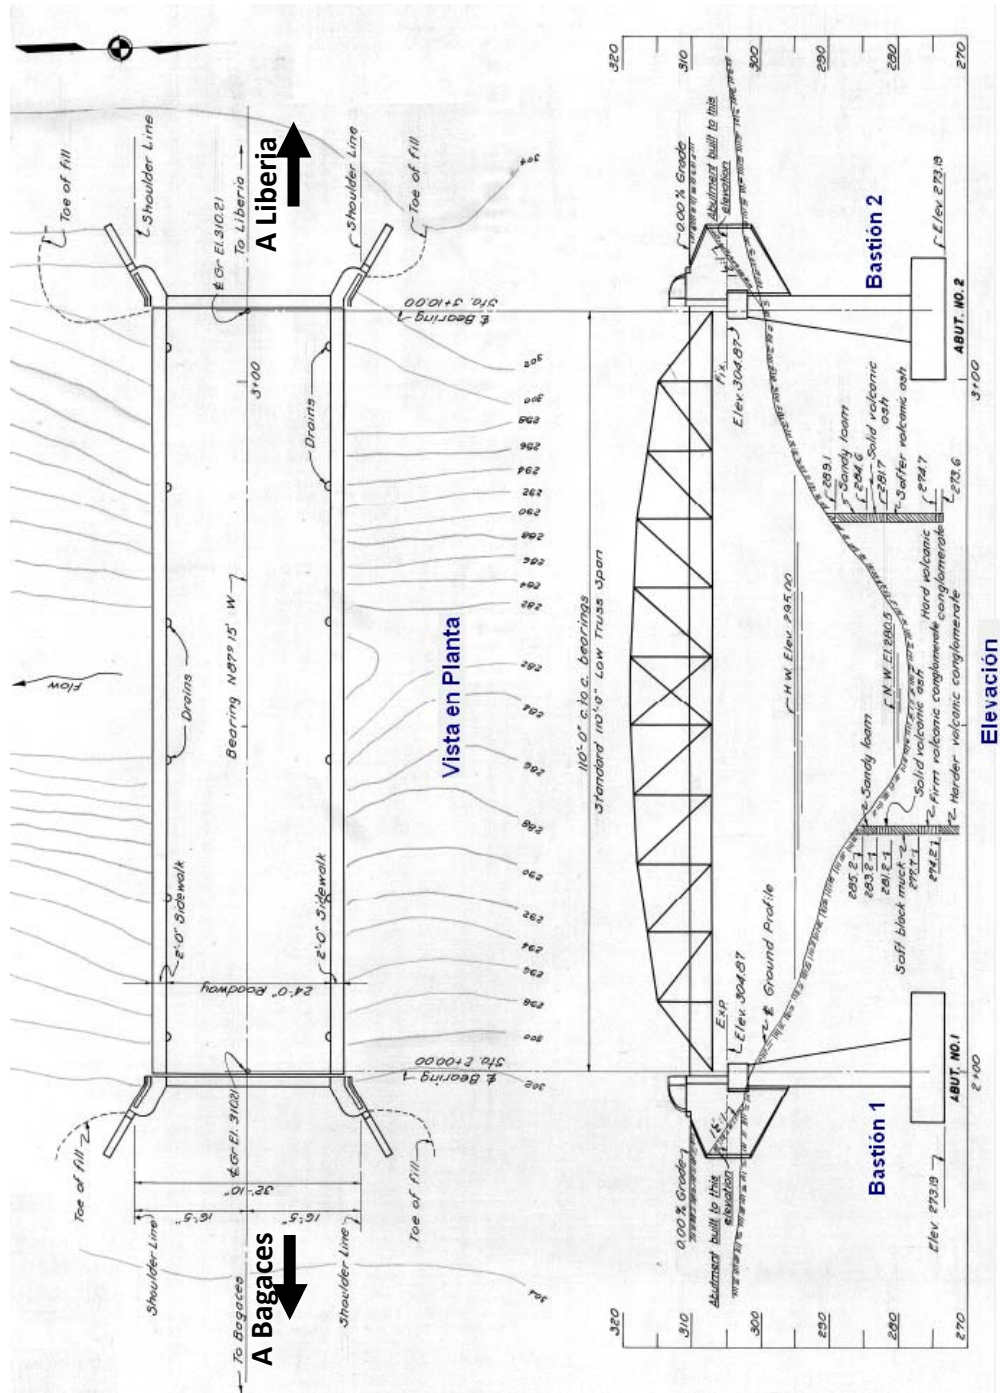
Vista en planta y en elevación en planos estructurales y nomenclatura utilizada para la identificación de los distintos componentes del puente sobre el río Potrero.
